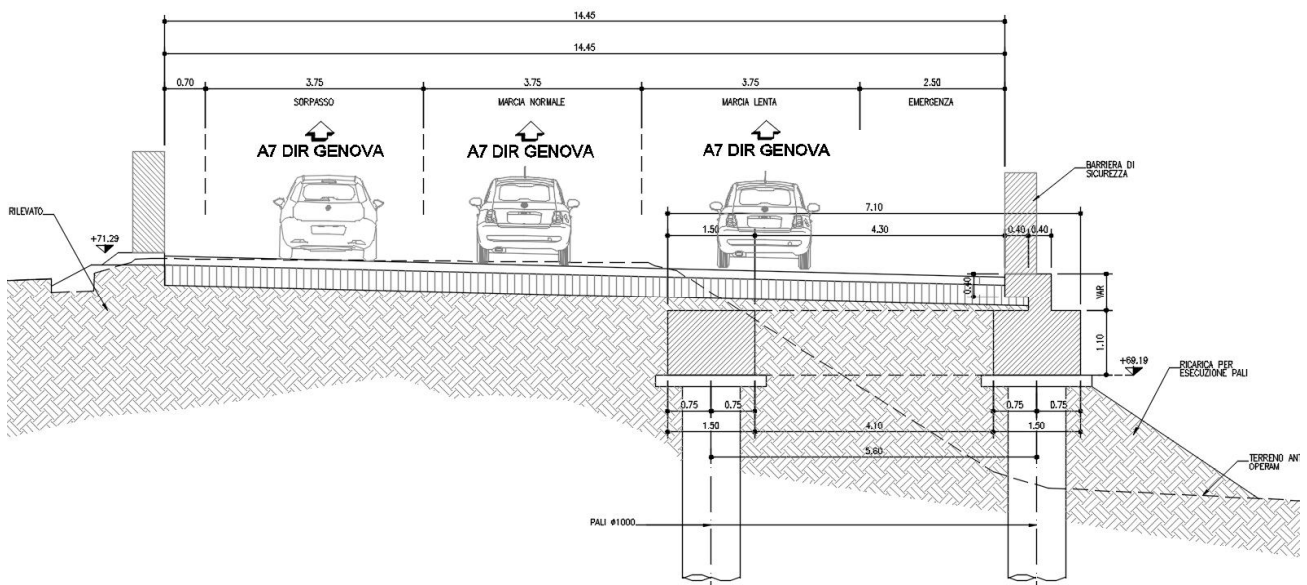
Spalla lato Genova - Sezione trasversale zona pali di ancoraggio
